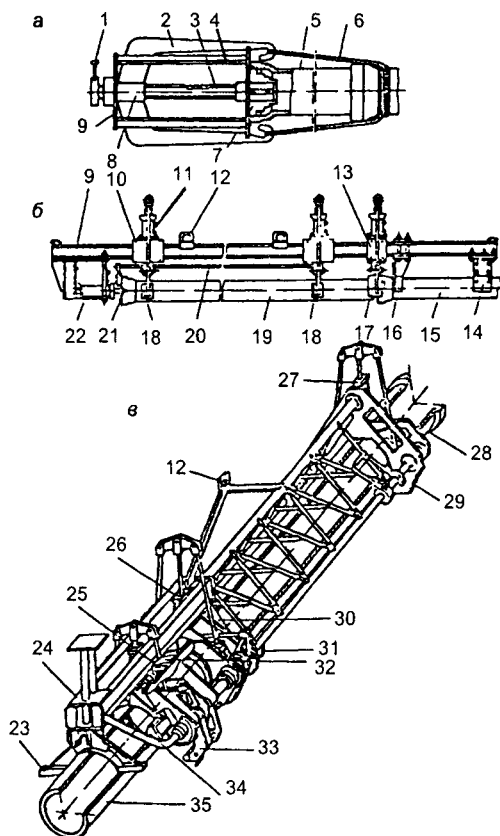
Схемы устройств и навесного оборудования для монтажа чугунных труб:
